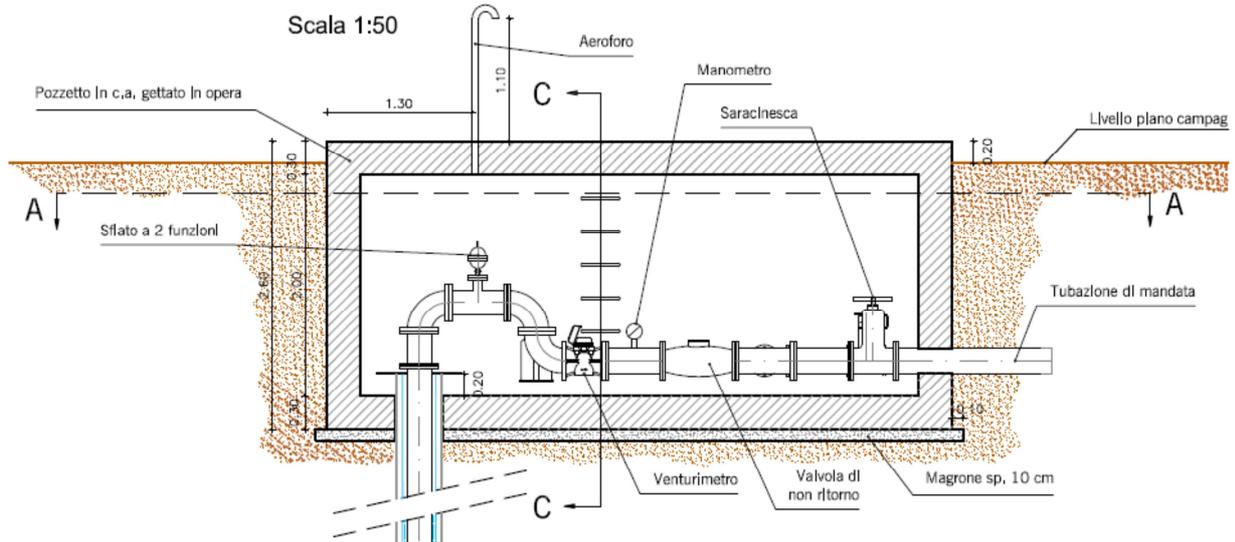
Pianta e sezione dei pozzetti di alloggiamento pompe.
